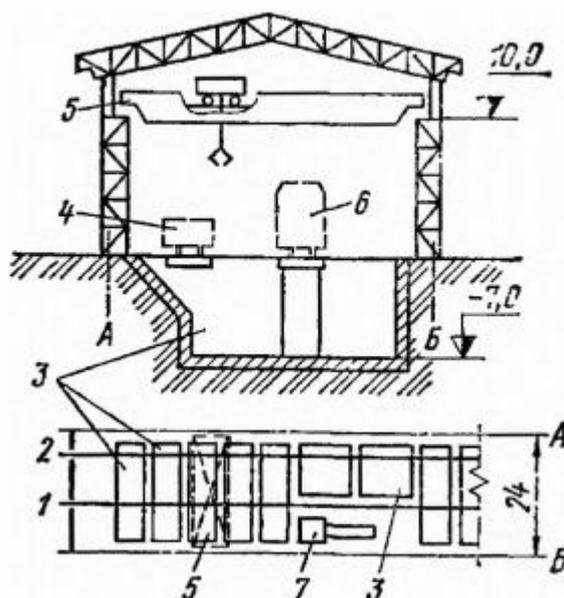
План и поперечный разрез шихтового отделения для сыпучих материалов
